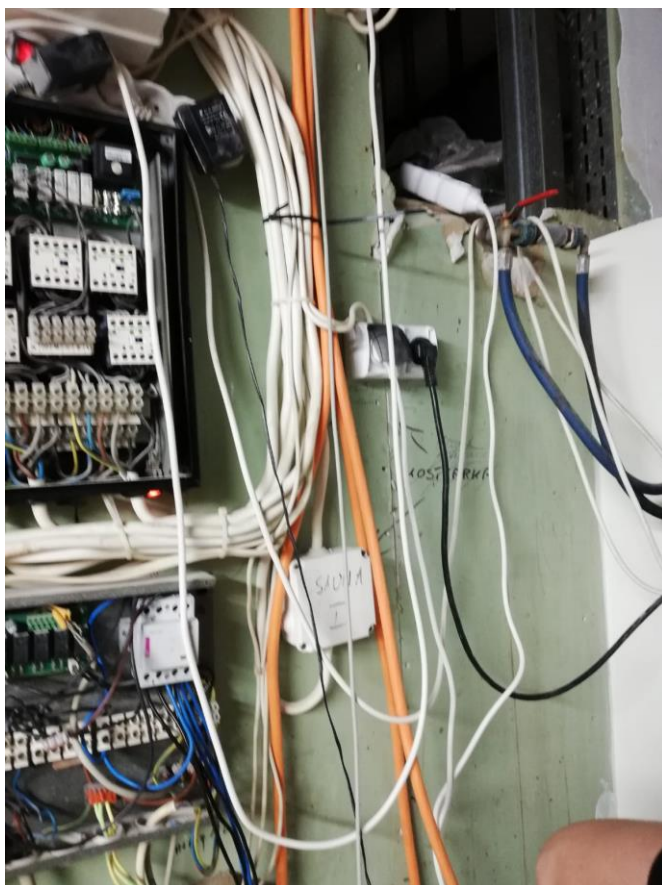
rozdzielnia elektryczna R-SA - widok wnętrza
